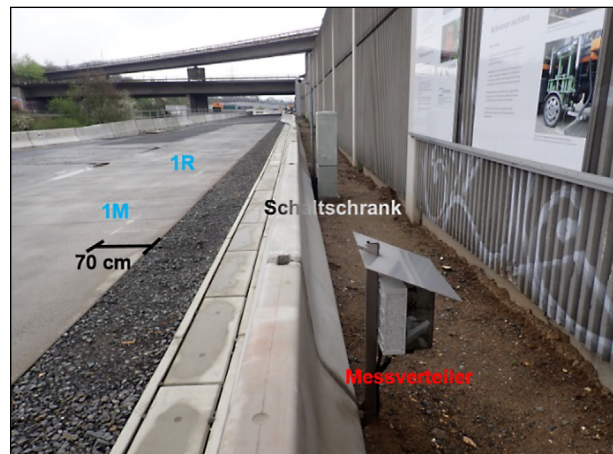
Sicht nach Süden auf dem Waschbetonabschnitt 40 des duraBAST
